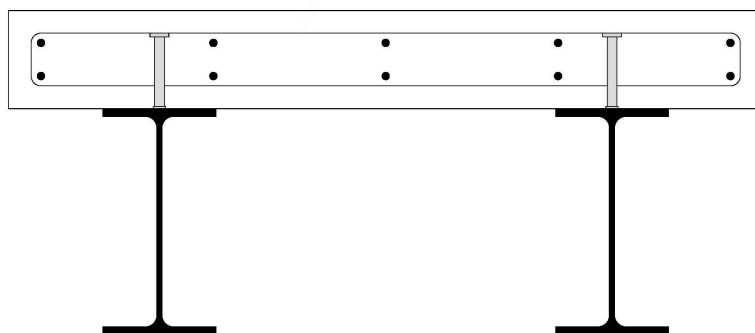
Corte Transversal a Meio Vão da Viga de Bancada Mista
